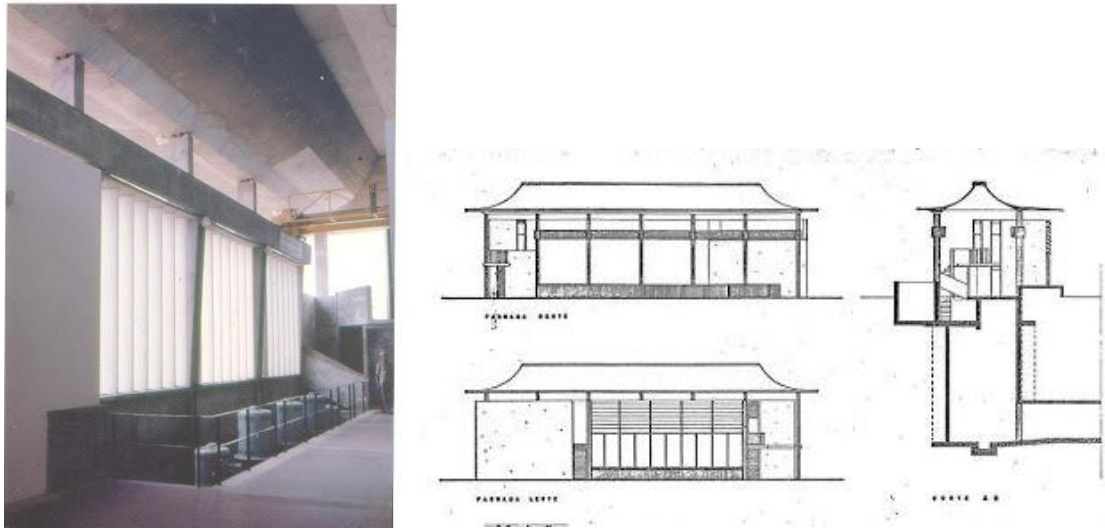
Vista interna da estação de bombeamento, elevações e corte.
